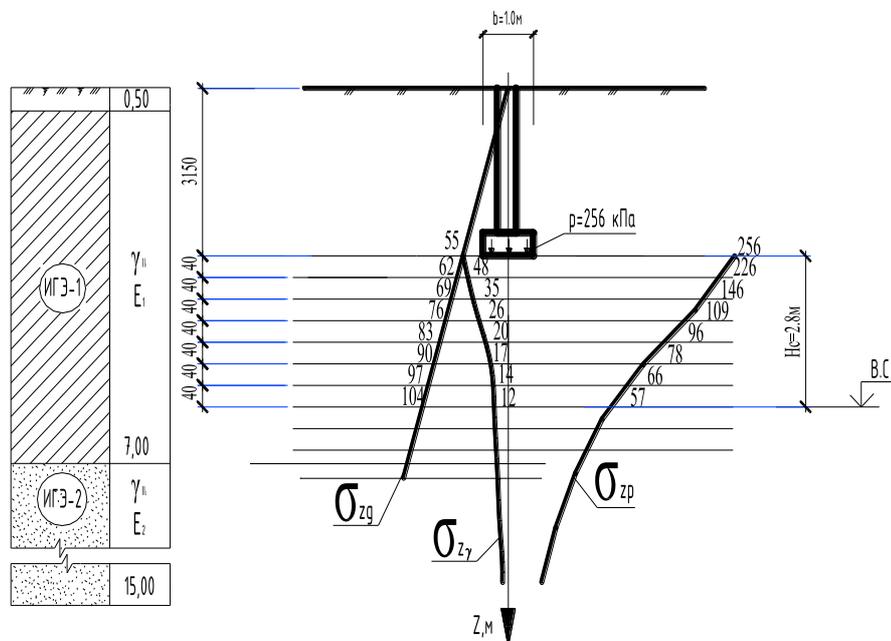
Схема к расчету осадки основания фундамента по методу послойного суммирования
